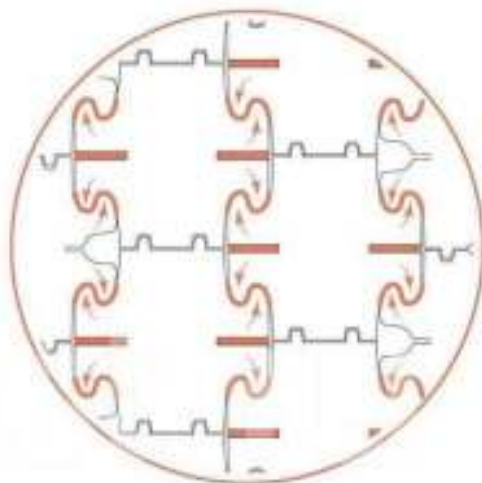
Макет стеновой конструкции. Фрагмент поперечного сечения стены [1]
